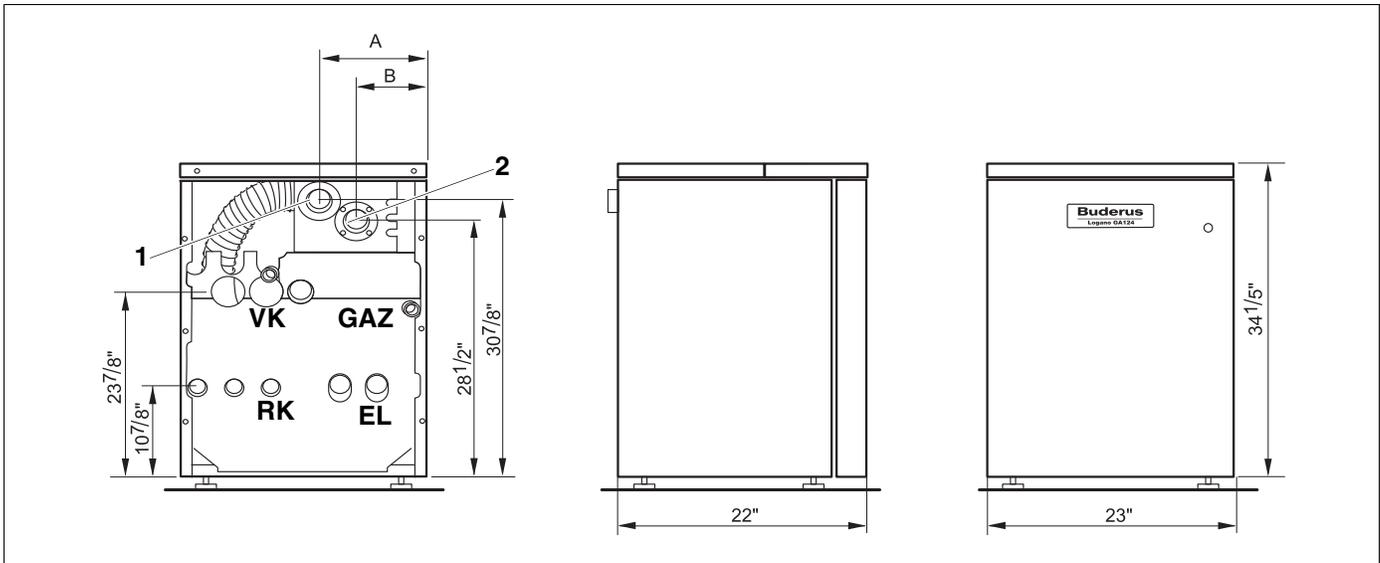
Vues arrière, latérale et avant (dimensions en pouces)
